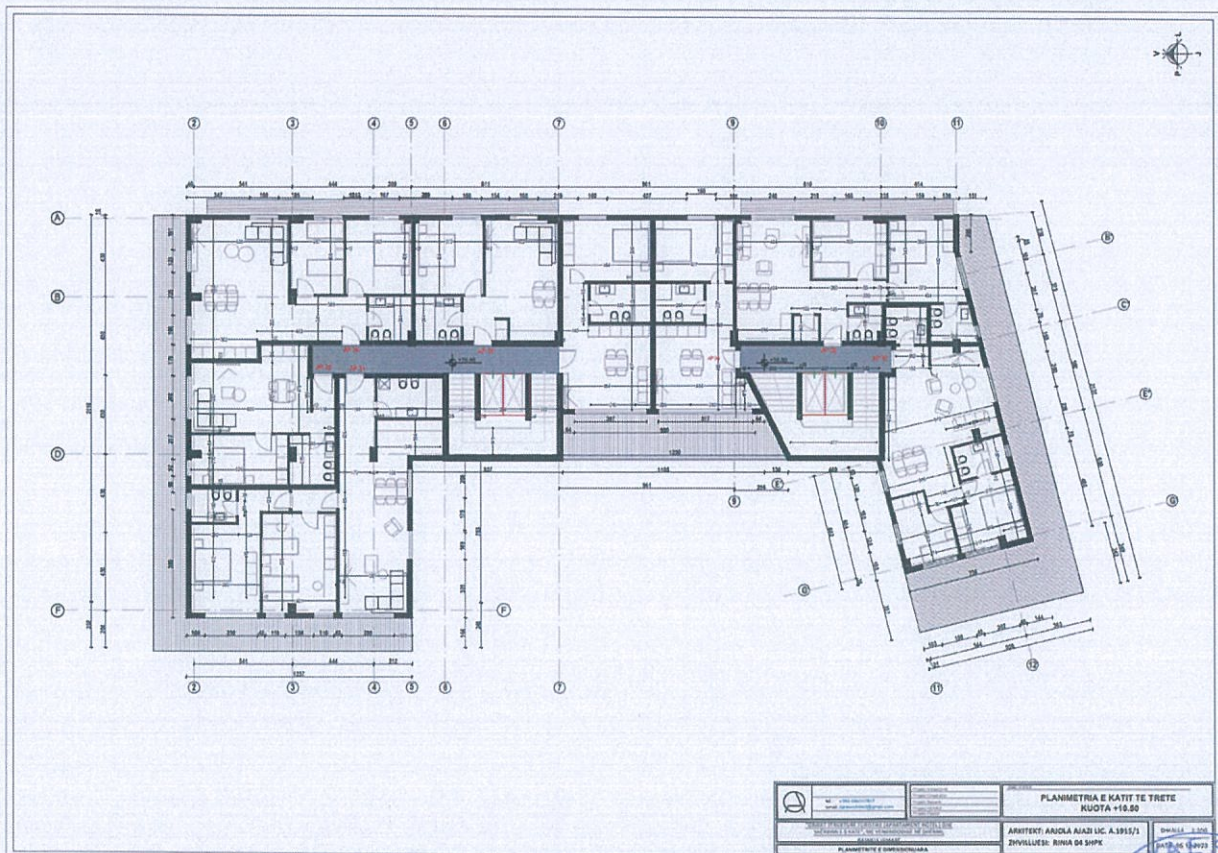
Planimetri e katit te trete (kuota 10.50)
